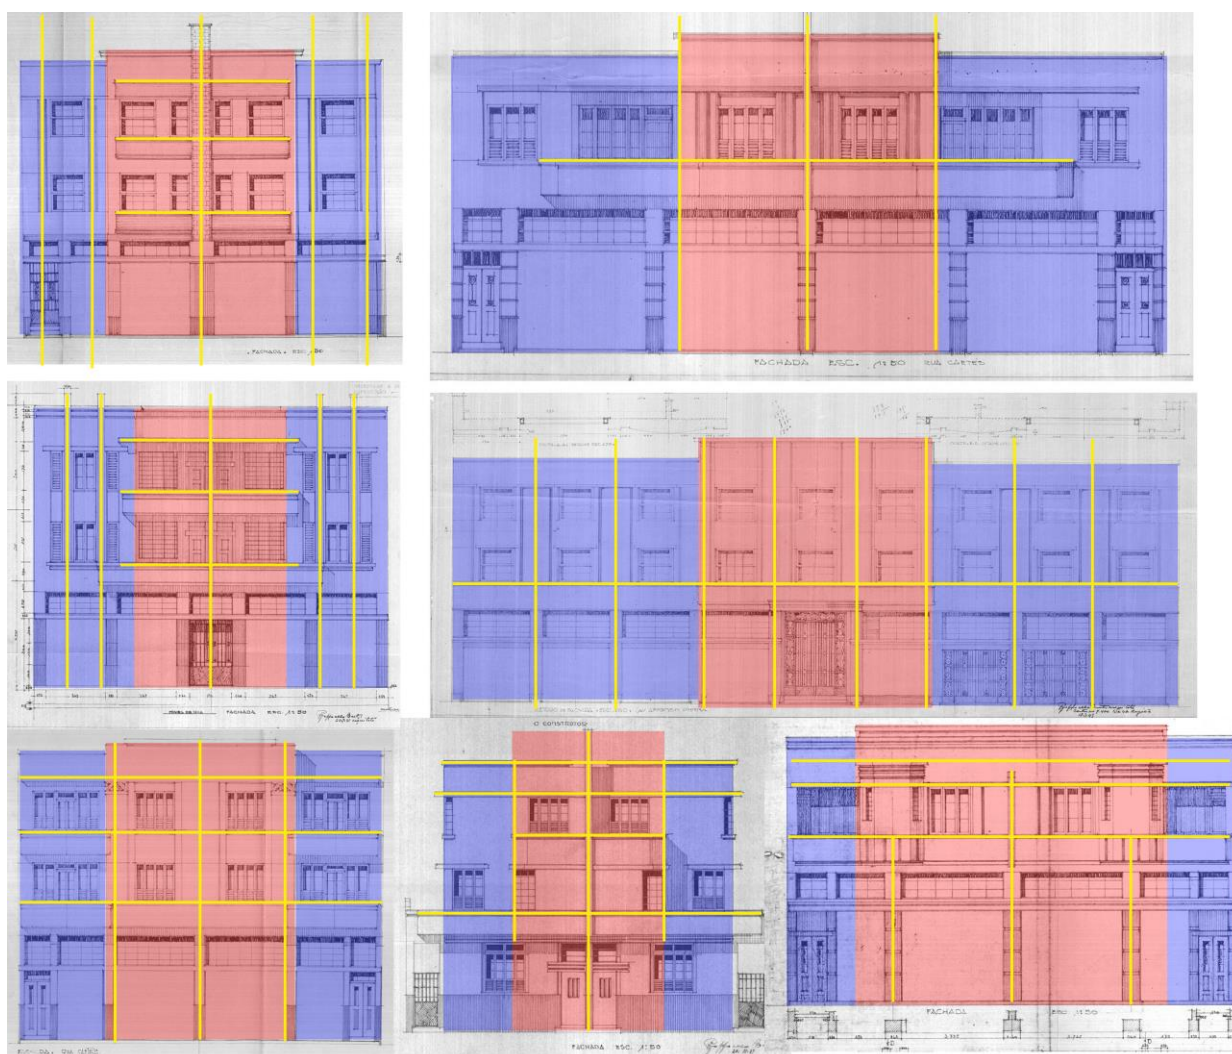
BERTI, R. Edificações de até três pavimentos diversas projetadas para o centro de Belo Horizonte, 1939-1944. Fachadas diversas. (projetos 291, 314,315, 337, 366, 388, e 403).
